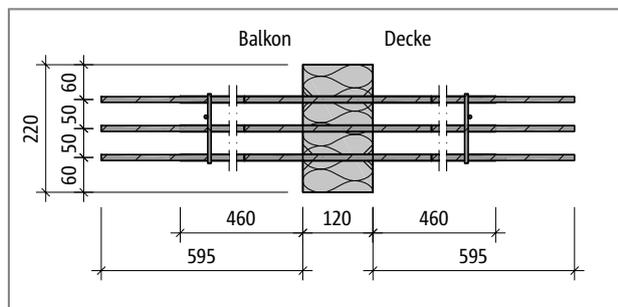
Schöck Isokorb® Typ SXT1-VB1: Produktgrundriss
